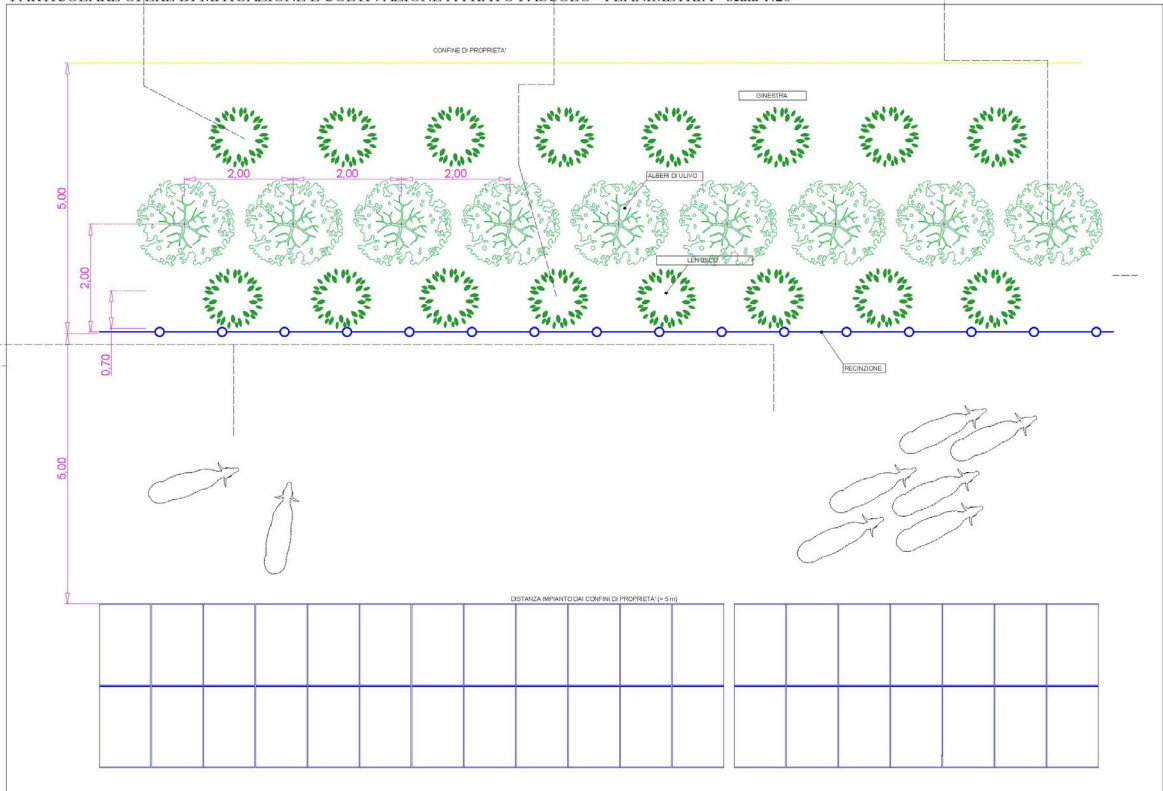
Opere di Mitigazione (Vista in Pianta)
